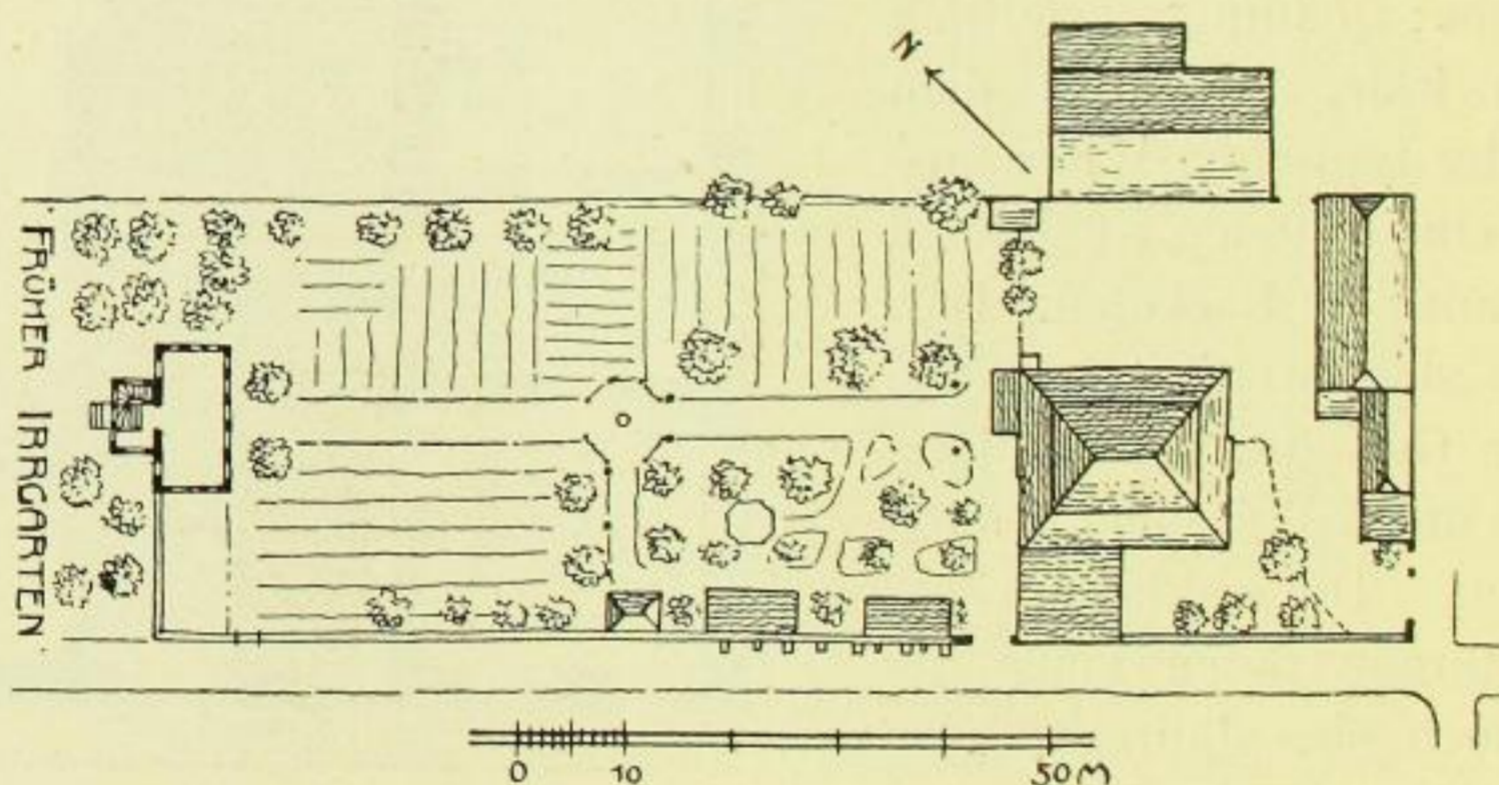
Eckartsberger Schlößchen, Lageplan.
